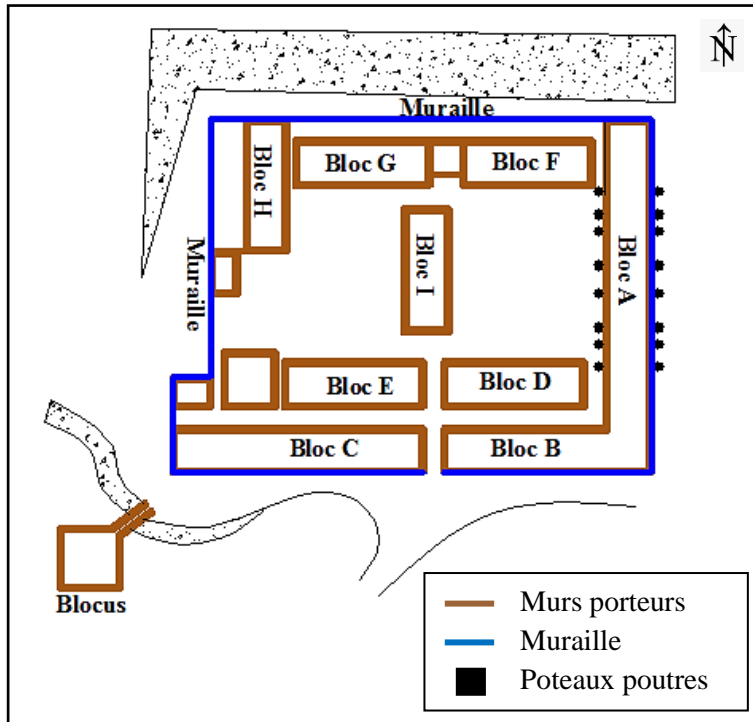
Plan montrant le système constructif. Source : Auteurs
